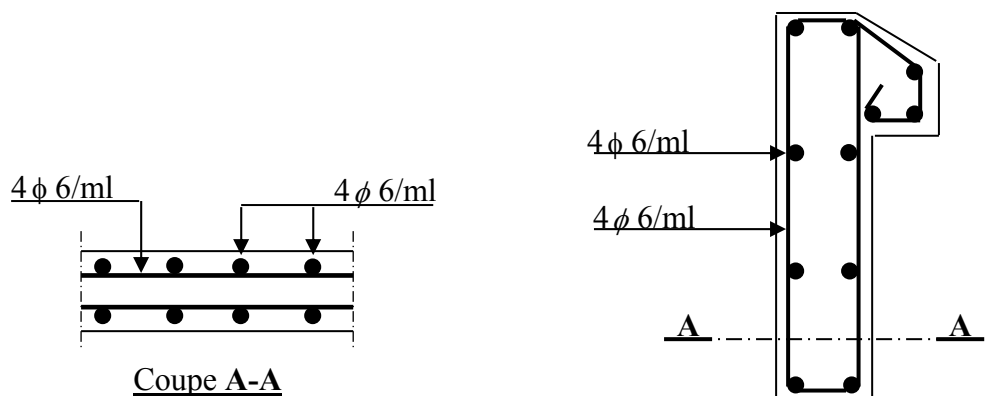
Schéma de ferrailage de l'acrotère type 2
